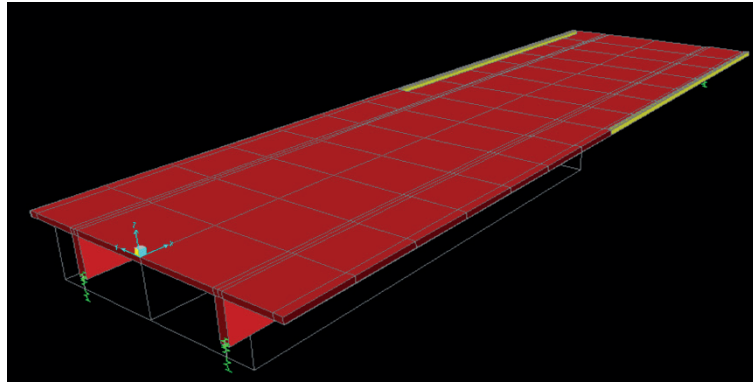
Modelo de ponte em vigas gerado pelo *bridge modeler* do SAP2000 (SILVA (2016))
